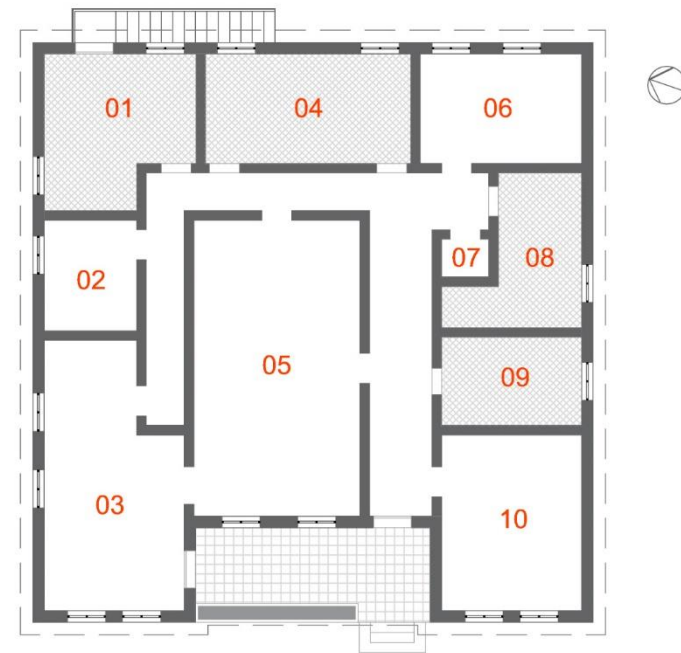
Casa E. Arq. John Adams [?], 1917. Planta baixa, escala 1:200.
